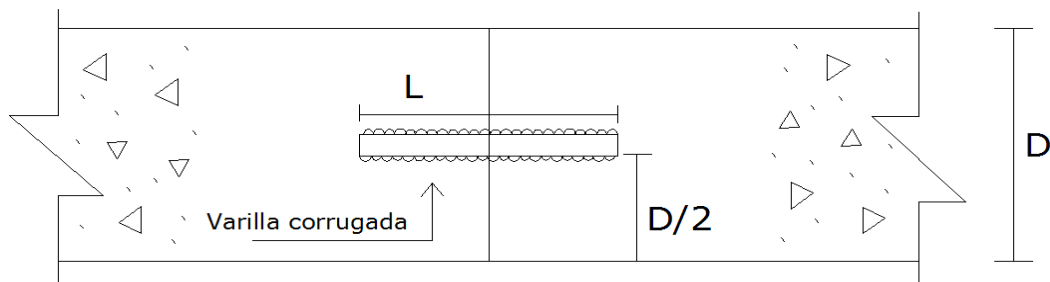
Pasajuntas de construcción para pavimentos rígidos.
